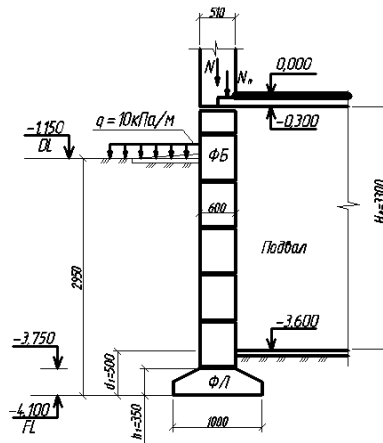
Расчетная схема и конструкция фундамента
